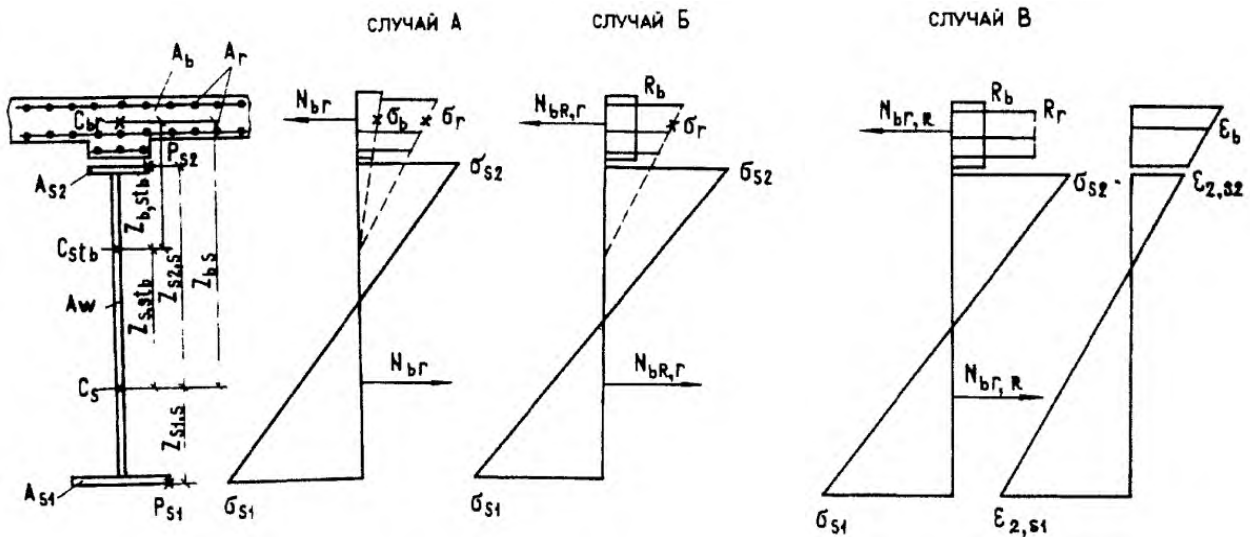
Усилия, напряжения и деформации в сталежелезобетонном поперечном сечении, воспринимающем положительный изгибающий момент
